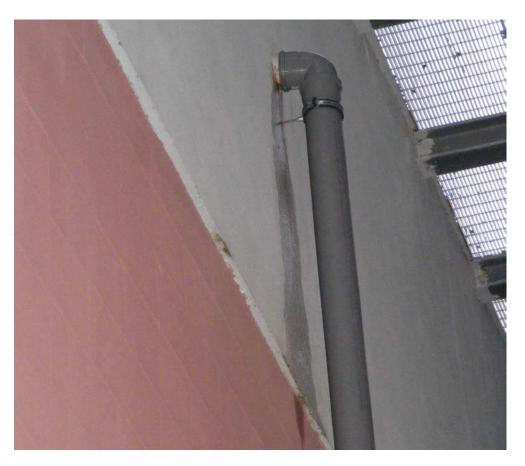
Perdita dal foro di alloggiamento del bocchettone
